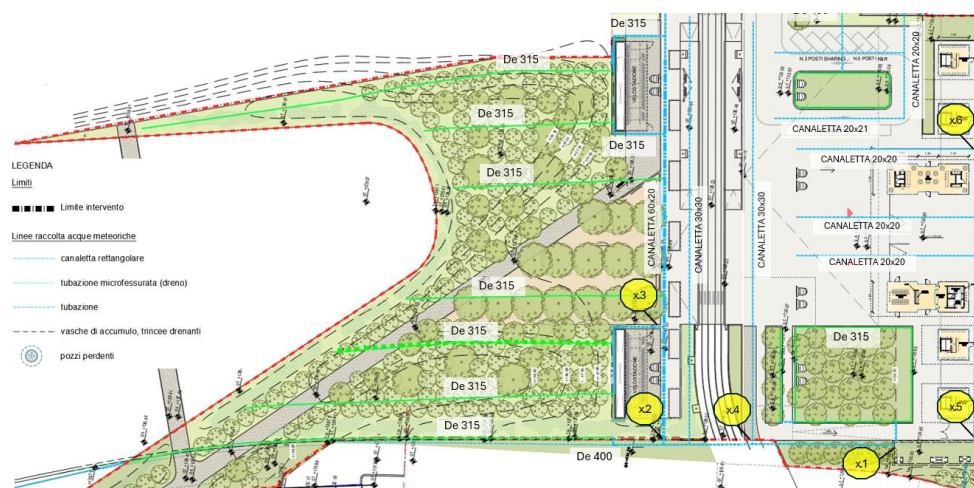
Stralcio planimetrico con sezioni di verifica
